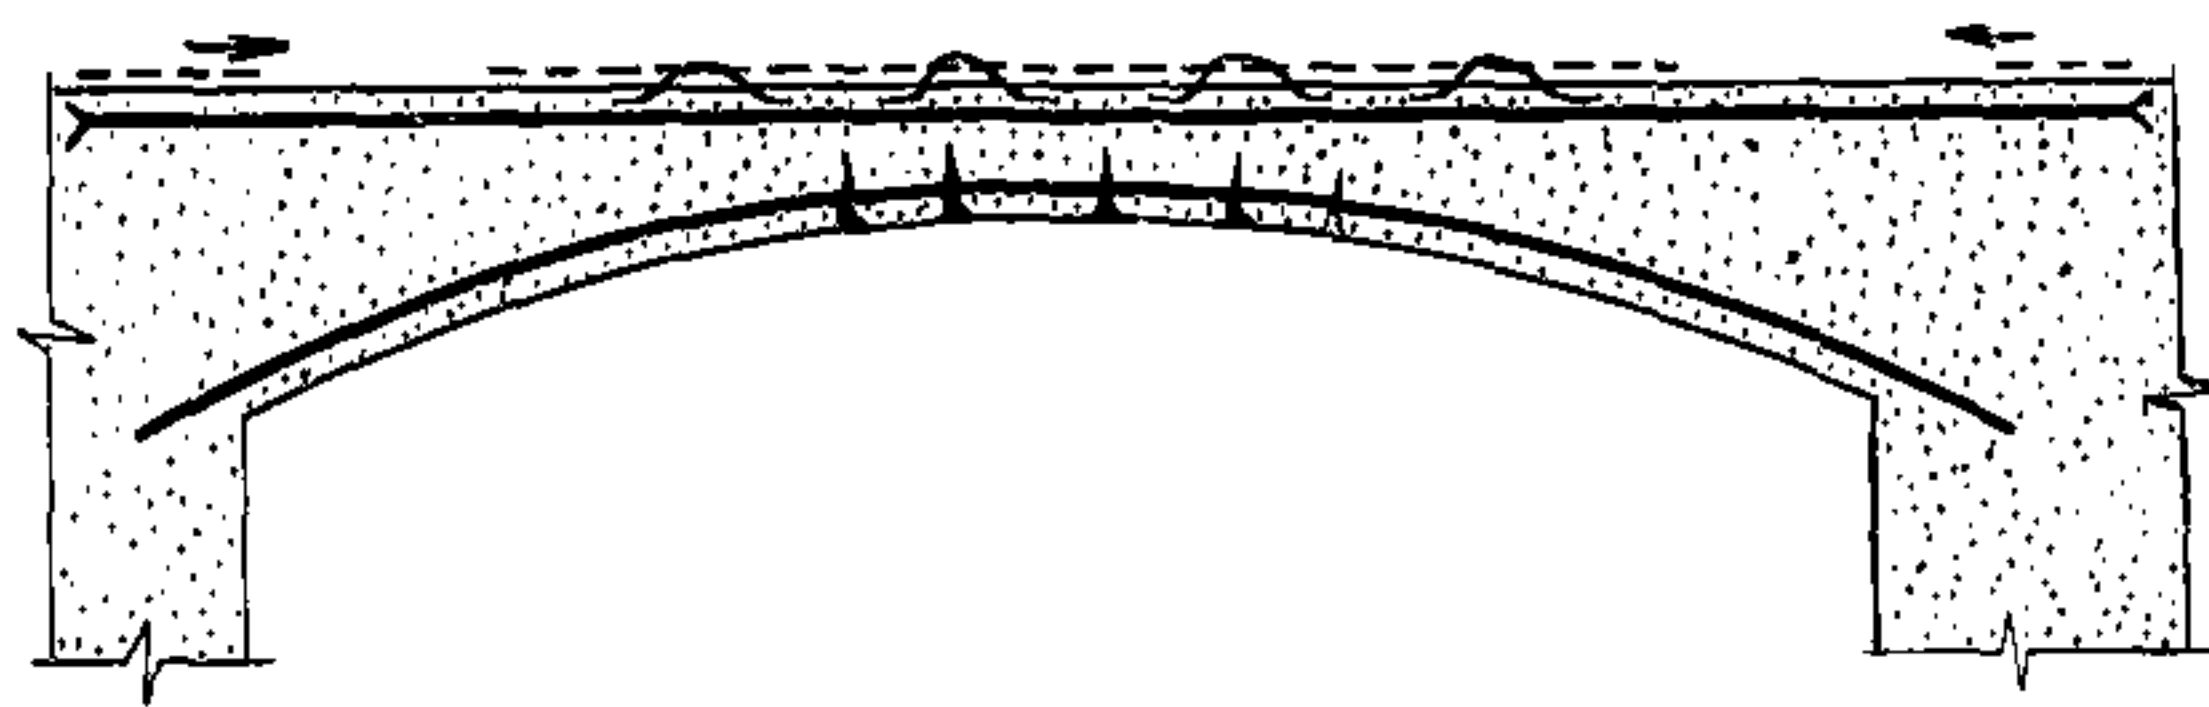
Характерные трещины (в растянутой зоне) железобетонного свода, проскальзывание арматуры на опорах, выкрашивание сжатой зоны бетона
